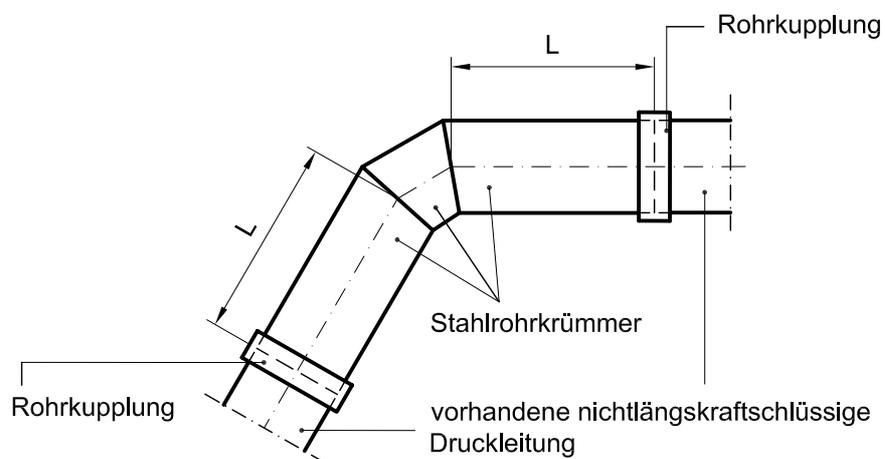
Stahlrohrkrümmer ohne Widerlager
